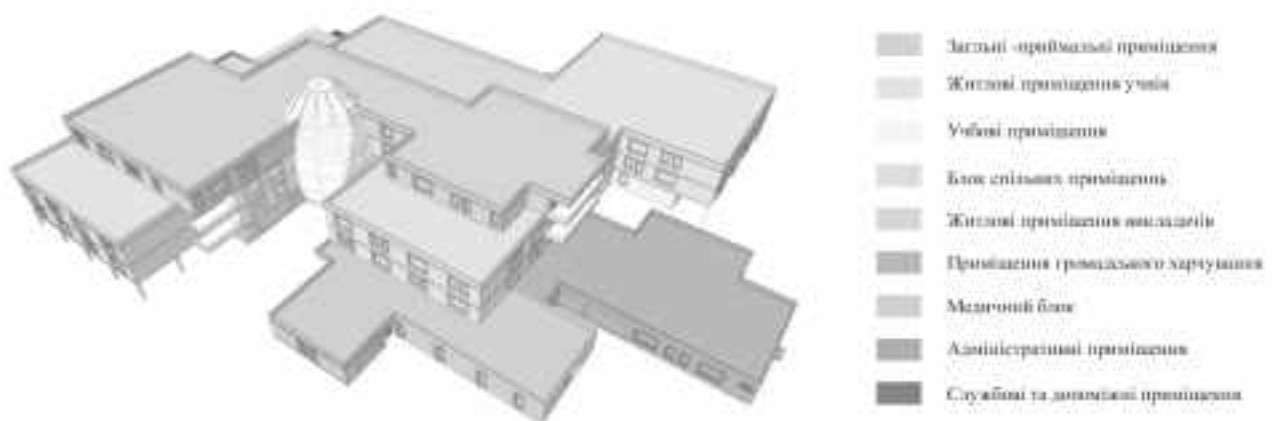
3D-схема функціонально-планувального розподілу будівлі
